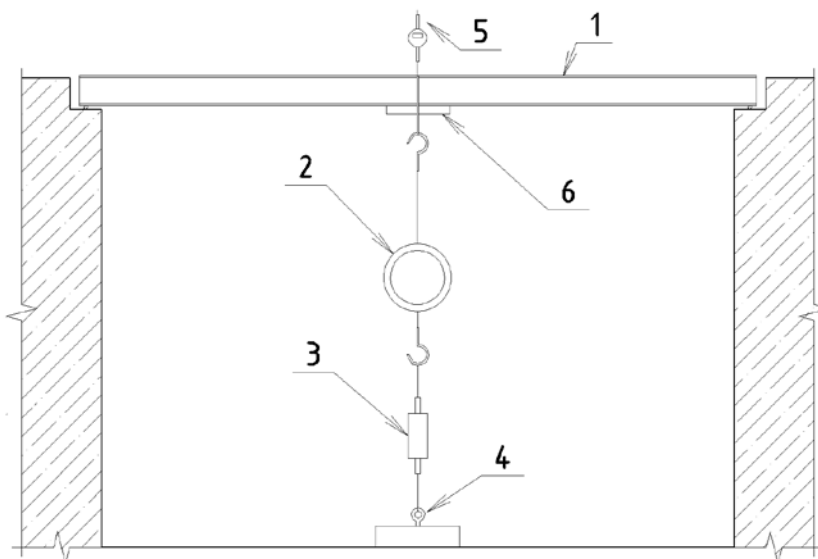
Стенд для испытания сосредоточенной нагрузкой
